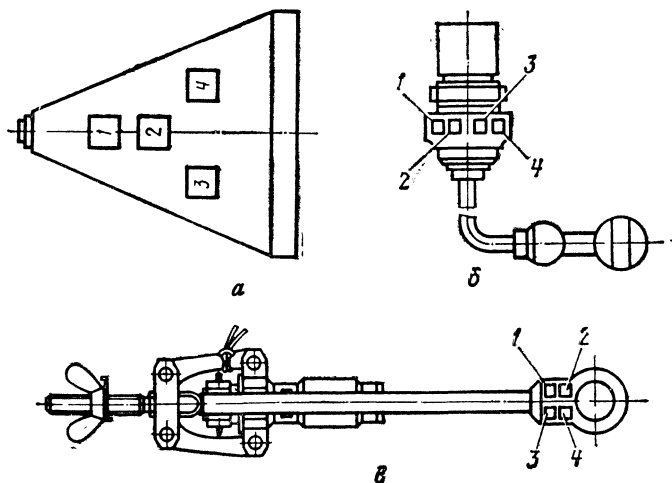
Маркировка обтекателя, механизма расщепления и командного прибора:
